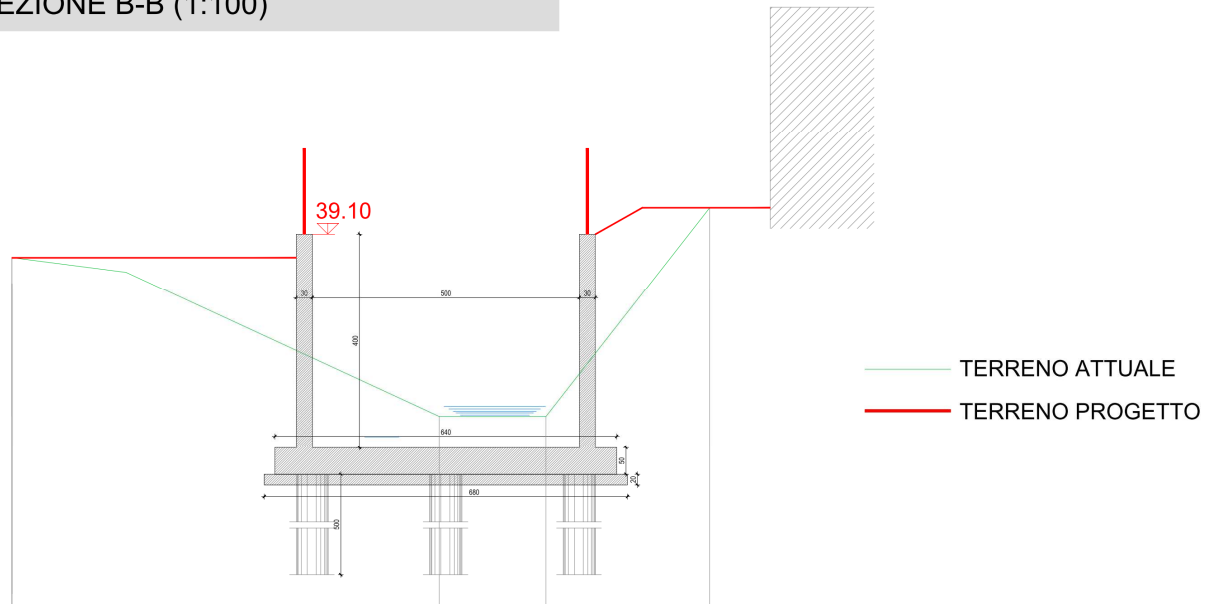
Stralcio sezione da PFTE Consorzio di Bonifica Marche
